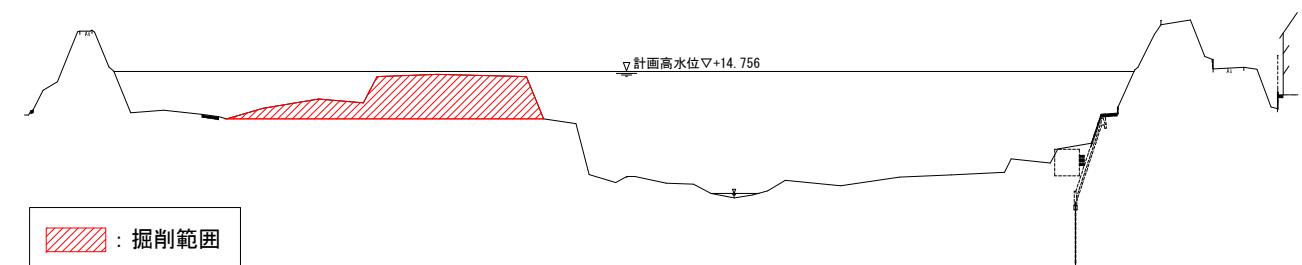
A-A断面図 (7.2k付近(No.28))
